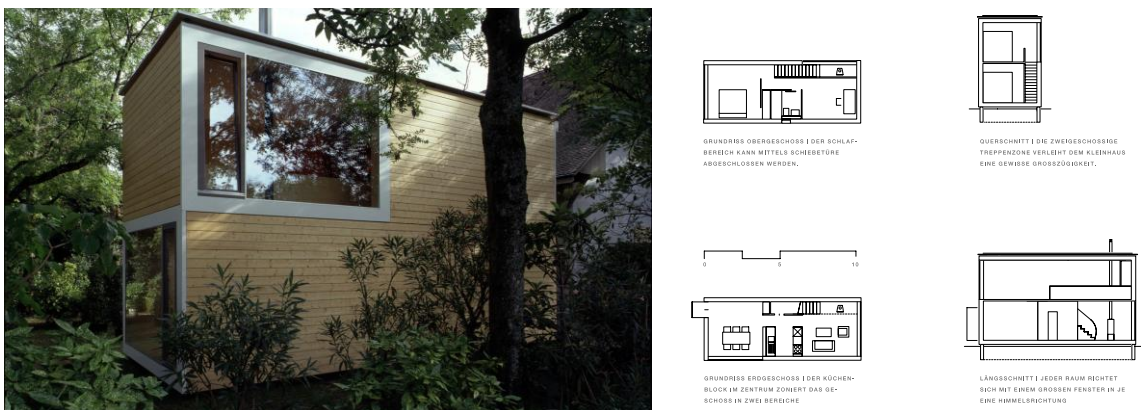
Smallhouse / Option, photo et plans / Bauart Architekten und Planer AG
